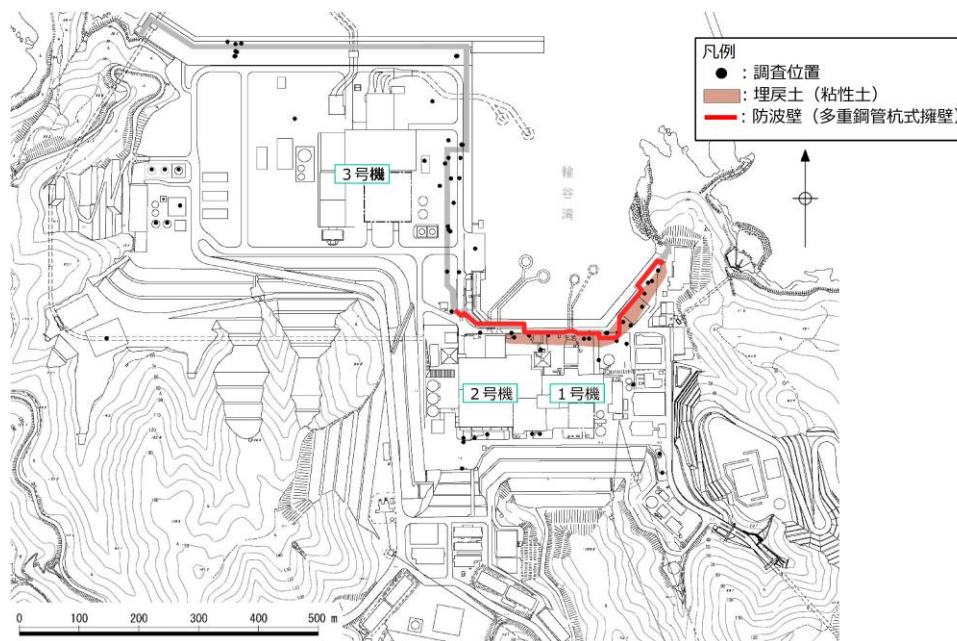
埋戻土（粘性土）の平面配置図
